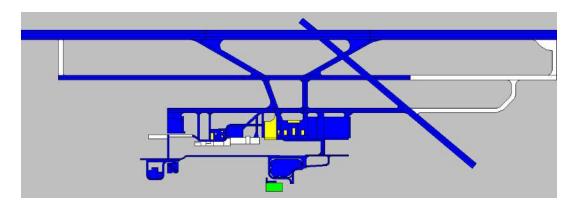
Plano de pavimentos acorde al tipo de pavimento en CUU
